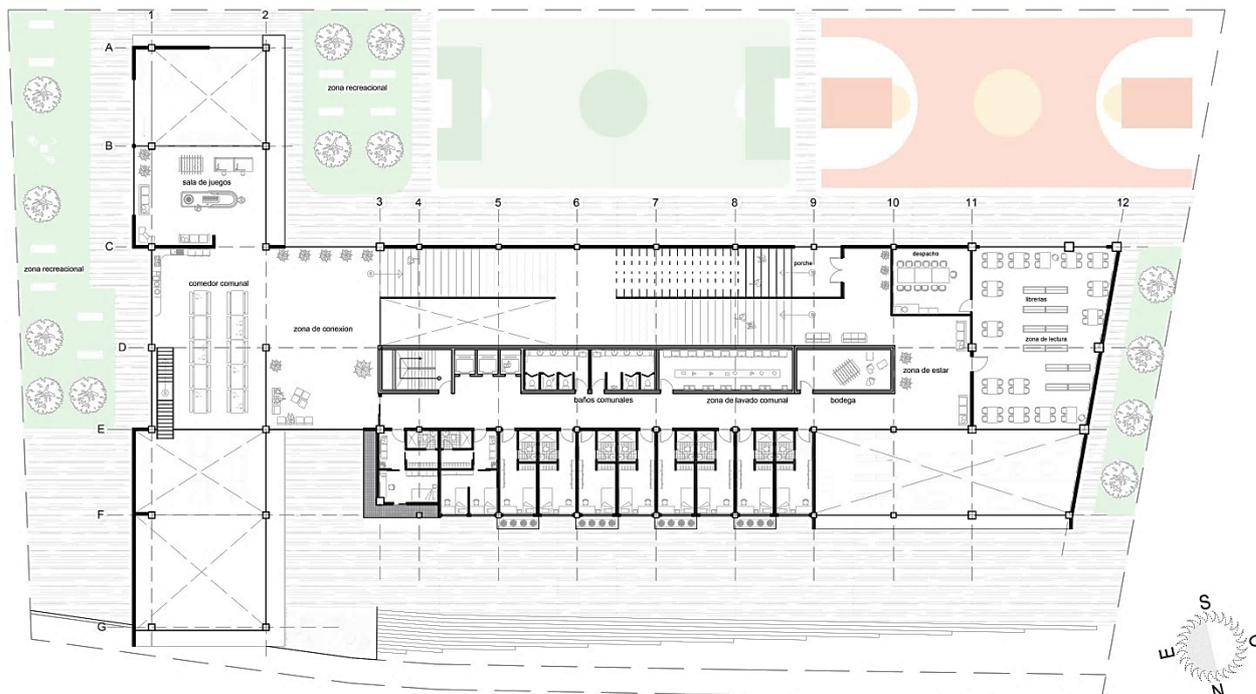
Planta: piso 4 Cevallos. (2018). Creación propia
